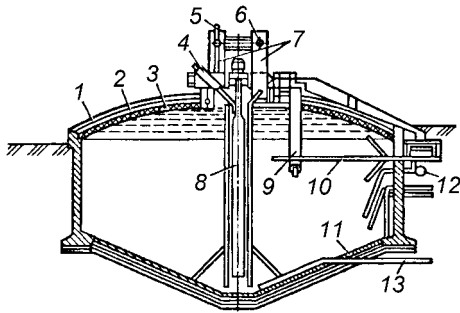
Схема заглибленого метантенка: 1 – м'яка покрівля; 2 – цегла; 3 – теплоізоляція; 4 – лок; 5, 9 – труби відповідно для випуску газу в атмосферу і переливання; 6 – газопровід для газового ковпака; 7 – газові ковпаки; 8-пропелерна мішалка; 10, 13 – трубопровід відповідно для завантаження і для спорожнювання метантенка; 11 – днище метантенка; 12 – паровий інжектор для підігріву метантенка
